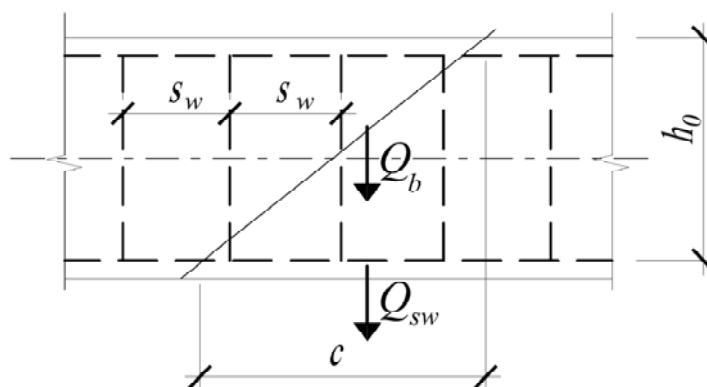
Схема усилий при расчете железобетонных элементов по наклонному сечению на действие поперечных сил по СНиП 52.101.2003.
